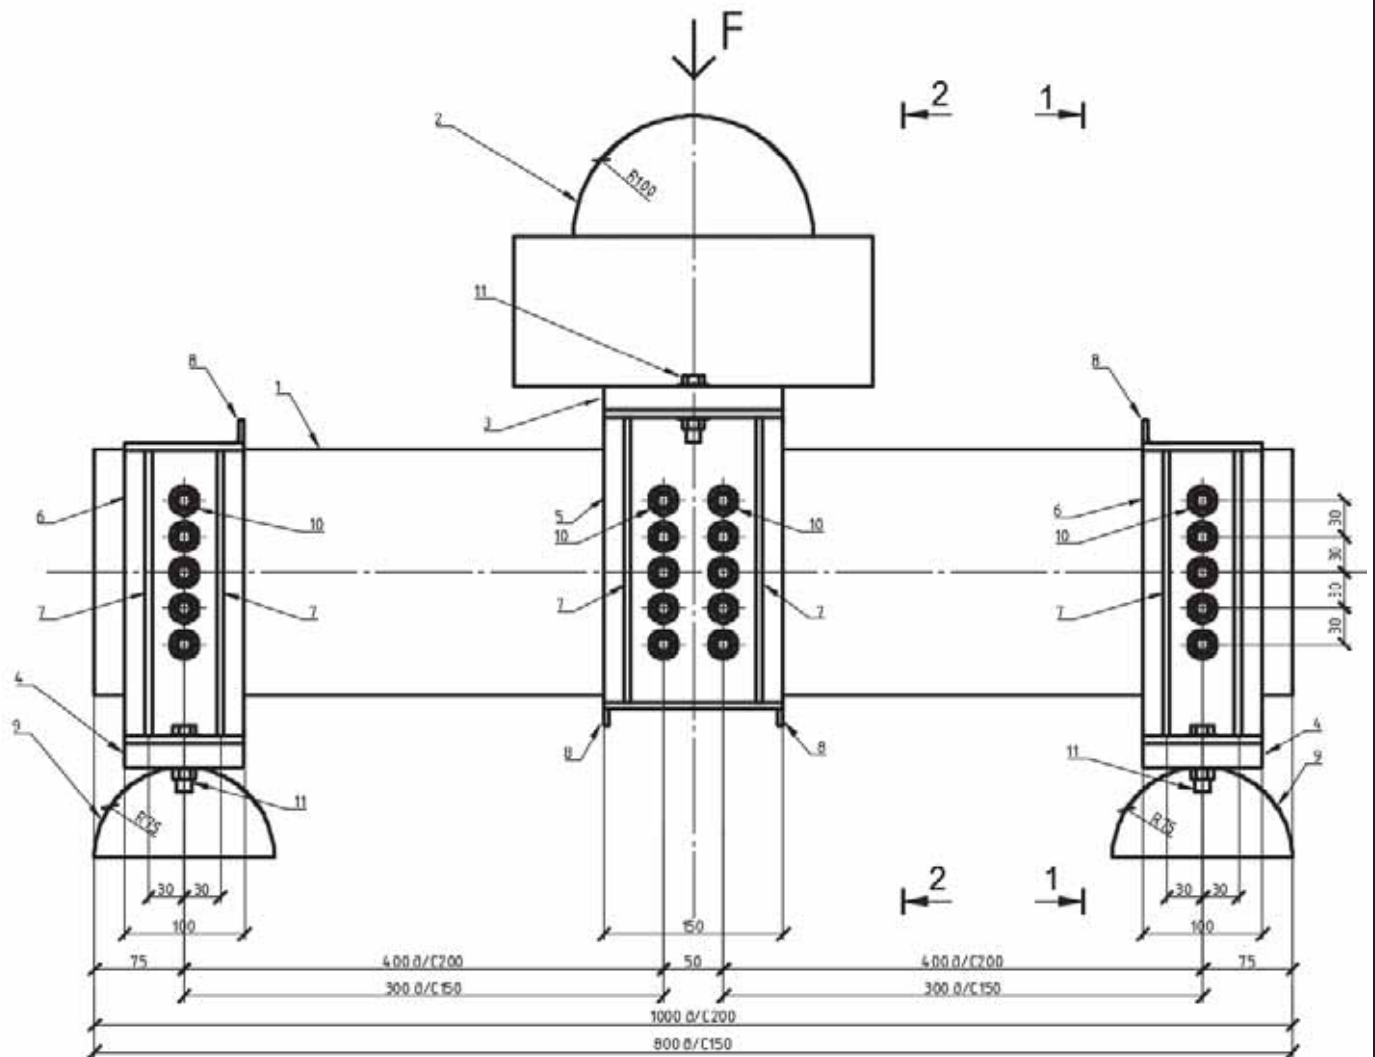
Схема установки для С200, вид слева М 1:4
